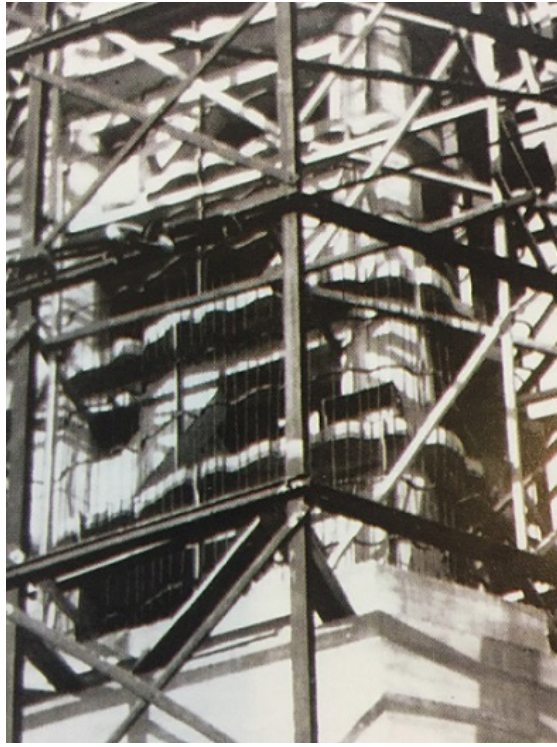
Detalhe da malha da estrutura externa do monumento composta por vergalhões gabaritados na horizontal e vergalhões de menor seção na vertical.
